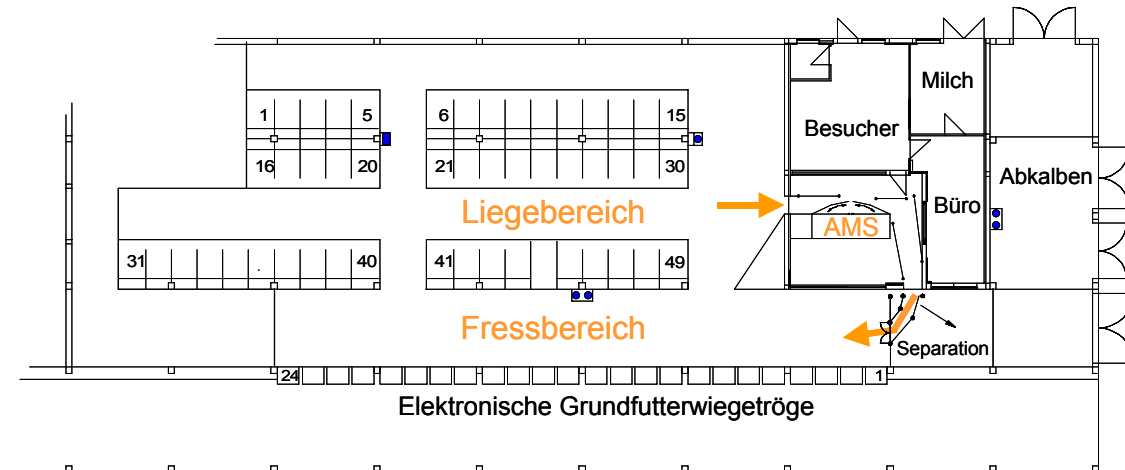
Grundriss des Stalls auf dem Betrieb Grub (AMS-Bereich)
